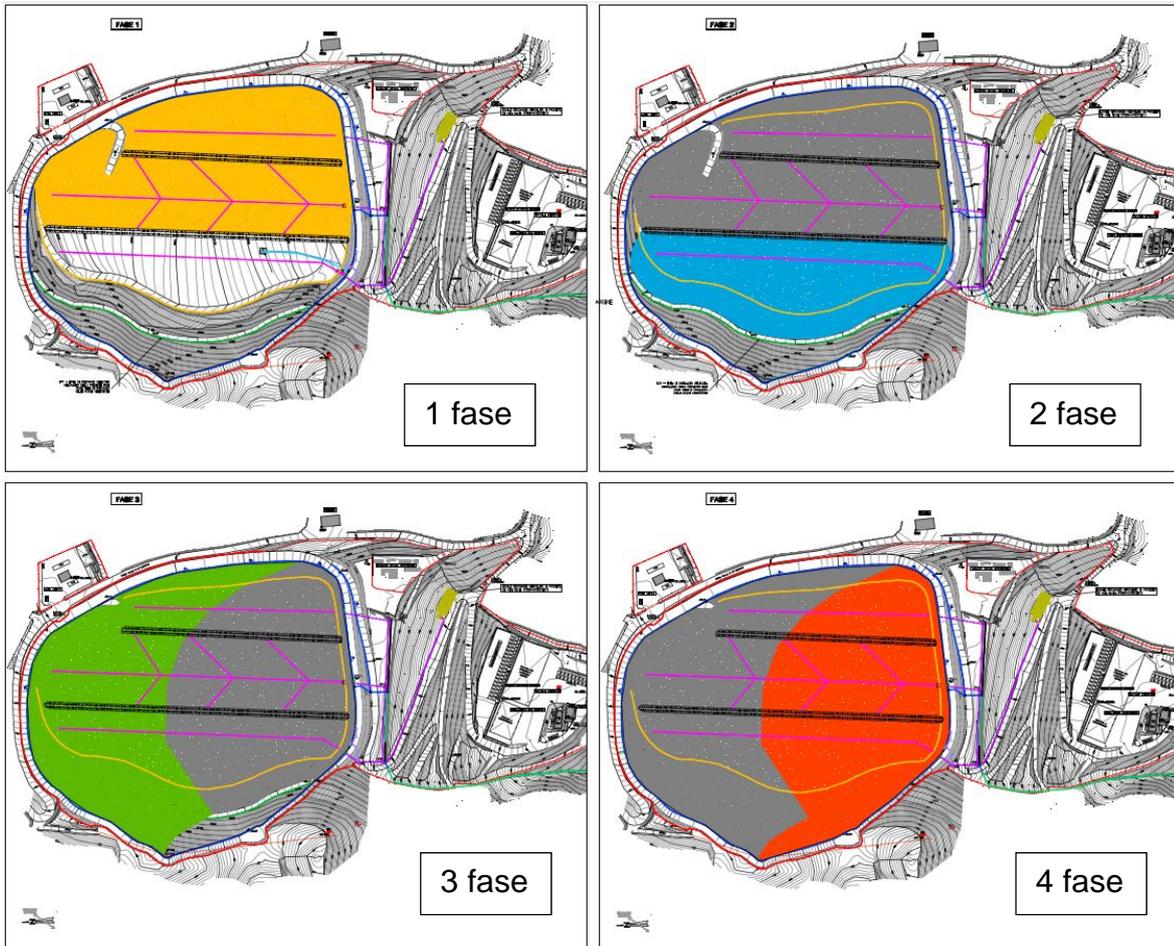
estratto della “Planimetria delle fasi di abbancamento” approvata
